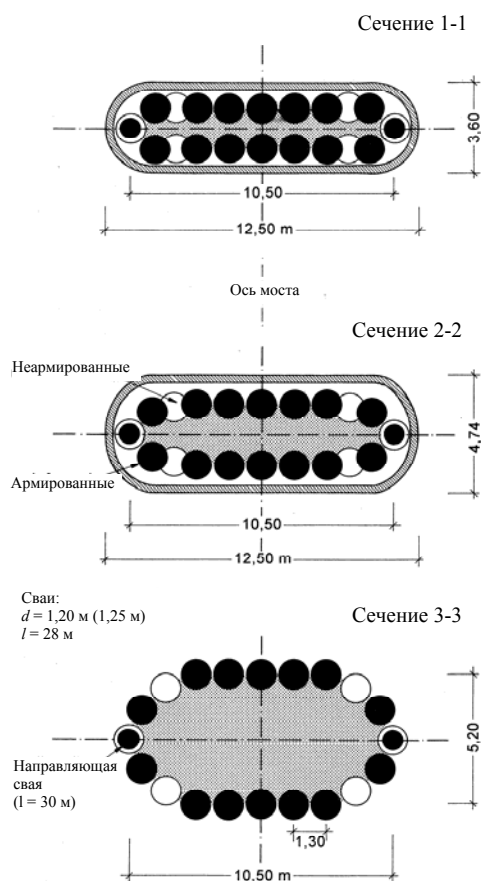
Поперечный разрез коробчатого фундамента на наклонных сваях: пример малого короба. Разрез 1-1 выполнен на уровне голов свай, разрез 3-3 – на уровне пят свай
